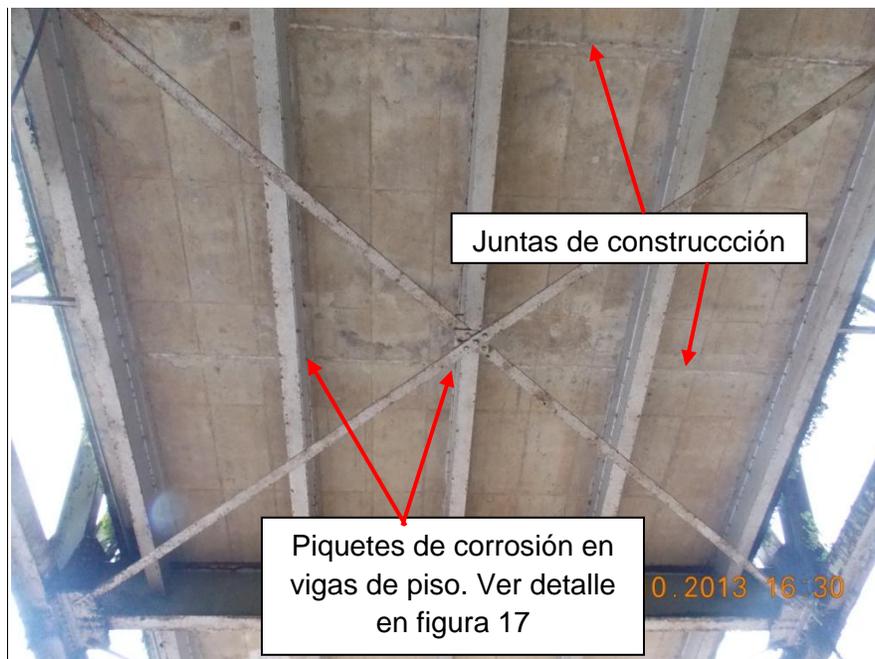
Eflorescencia a través de las juntas de construcción en la superficie inferior de la losa y piquetes de corrosión en vigas de piso(típico)
